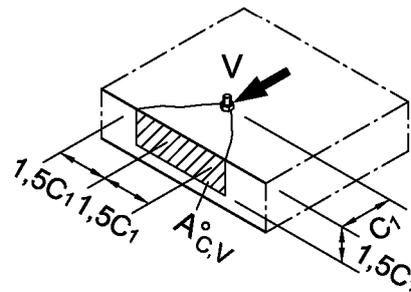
Beispiele für vorhandene Flächen der idealisierten Betonausbruchkörper für Ankerbolzengruppen unter Querbeanspruchung
